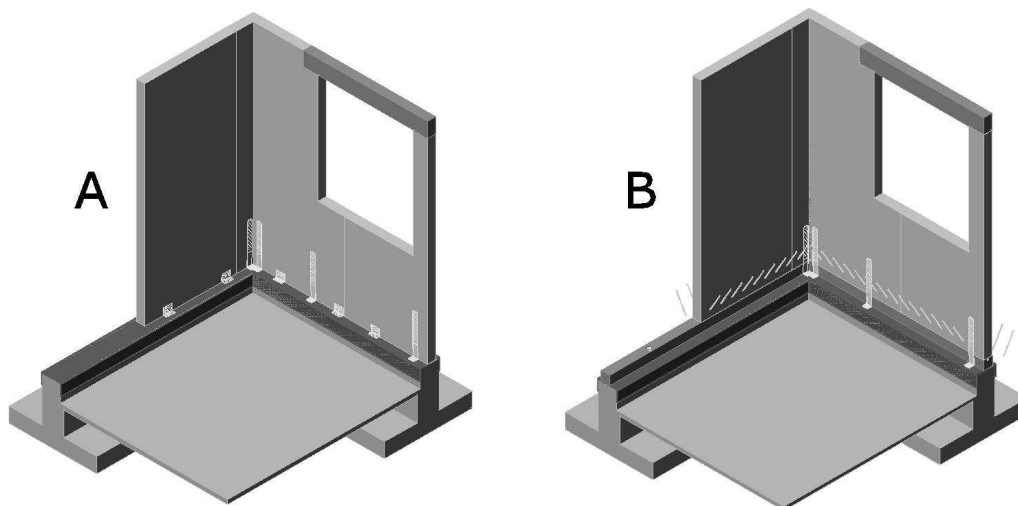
Collegamento delle pareti alle fondazioni. A: pareti direttamente collegate al cordolo di calcestruzzo, B: pareti collegate mediante l'interposizione di un cordolo di legno.
